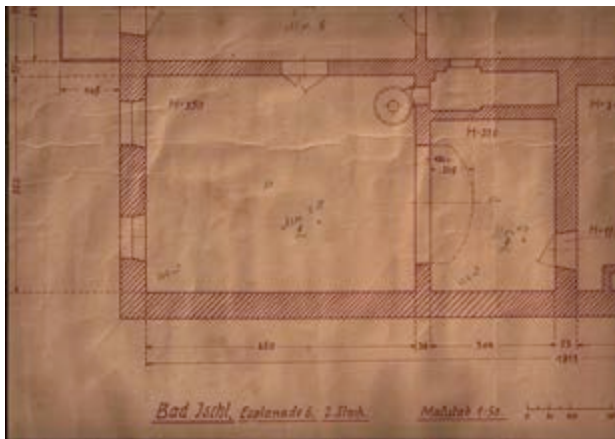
Ausschnitt Bauplan M 1:50, Haus Esplanade 6, 2. Stock, 1930
